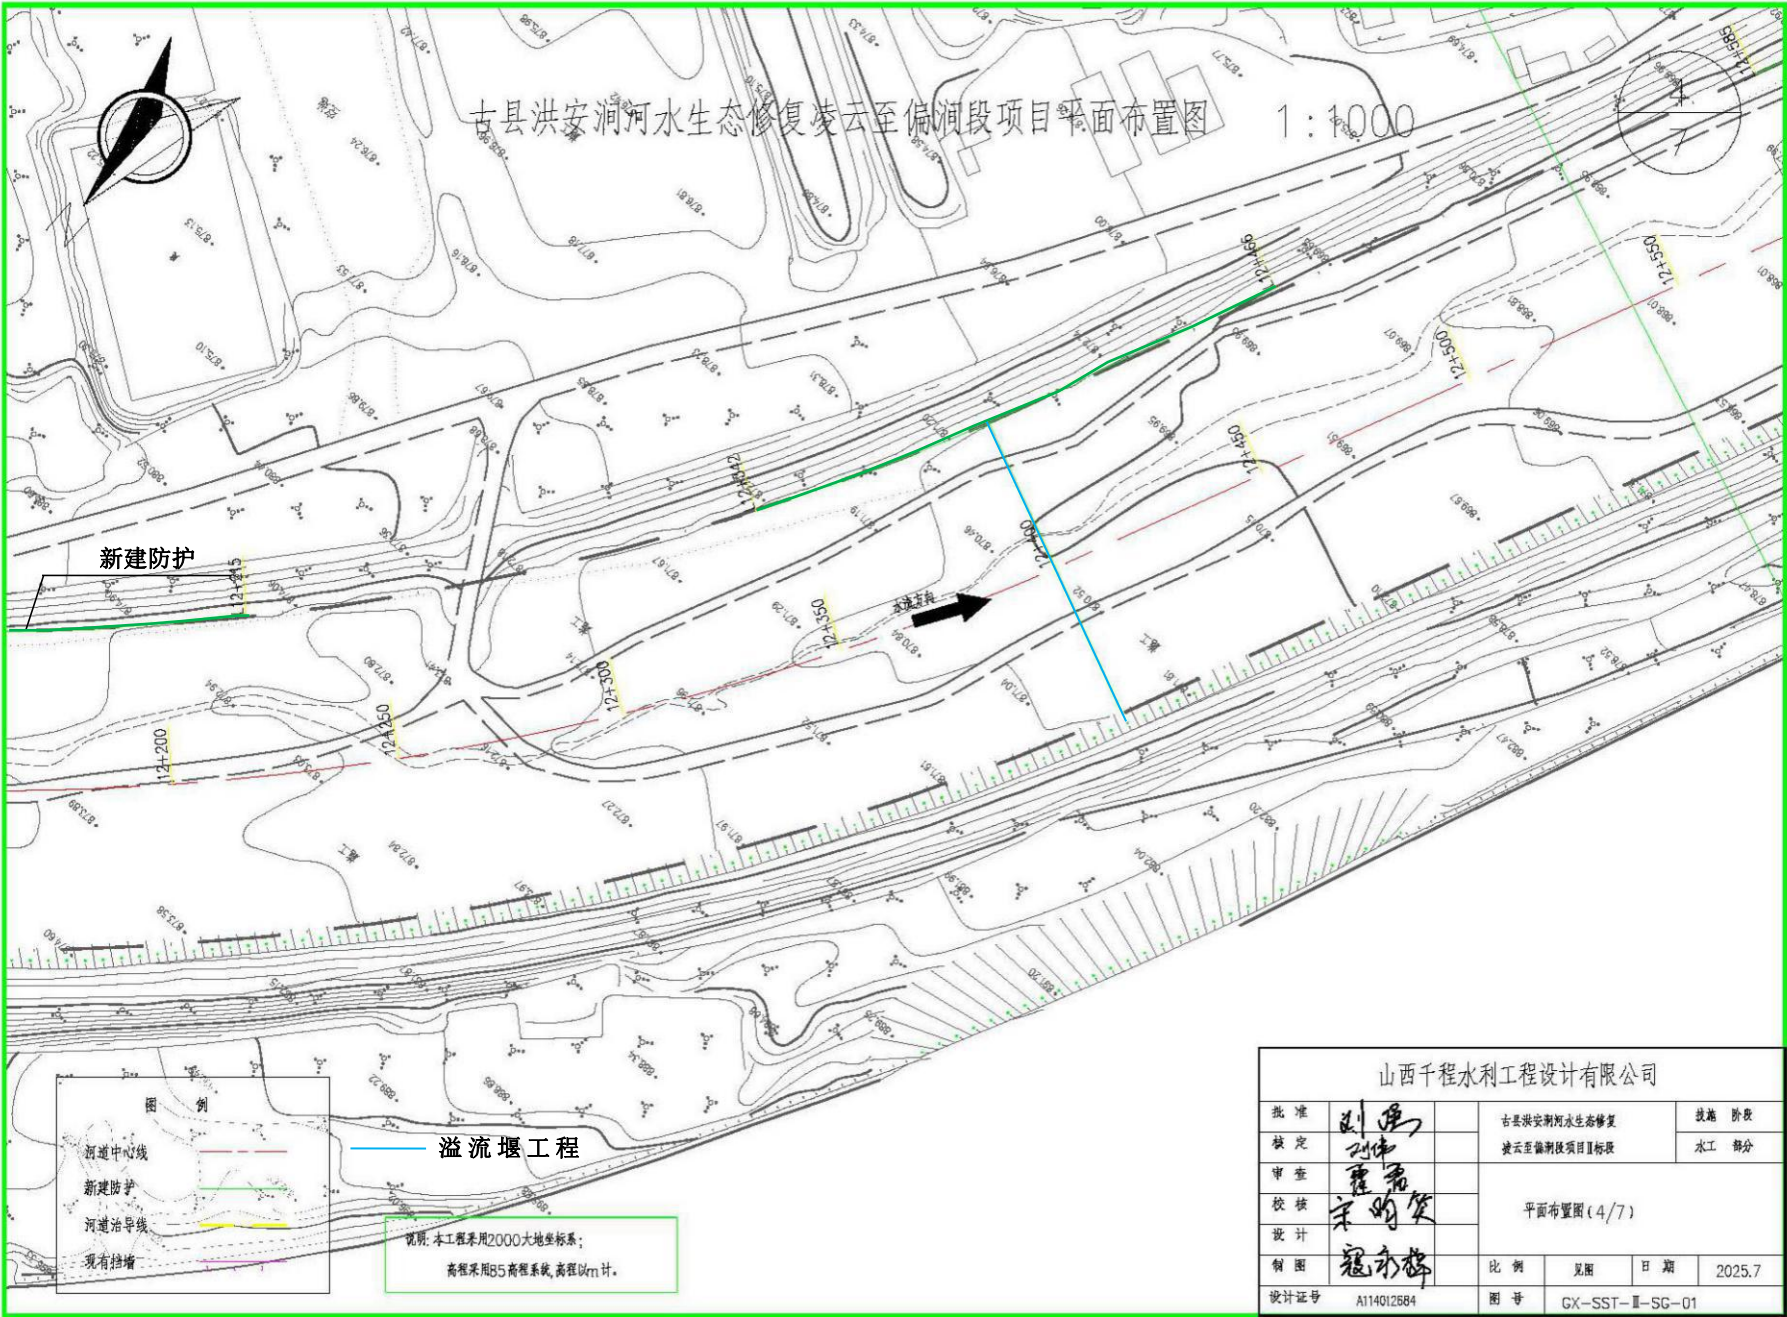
(8) 工程总平面布置图(桩号 12+150-12+550)
